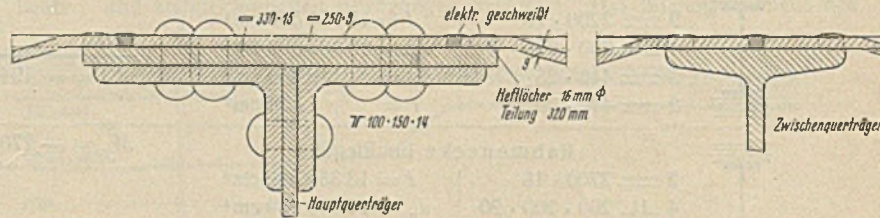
Buckelblechverschweißung auf den Fahrbahnträgern.
